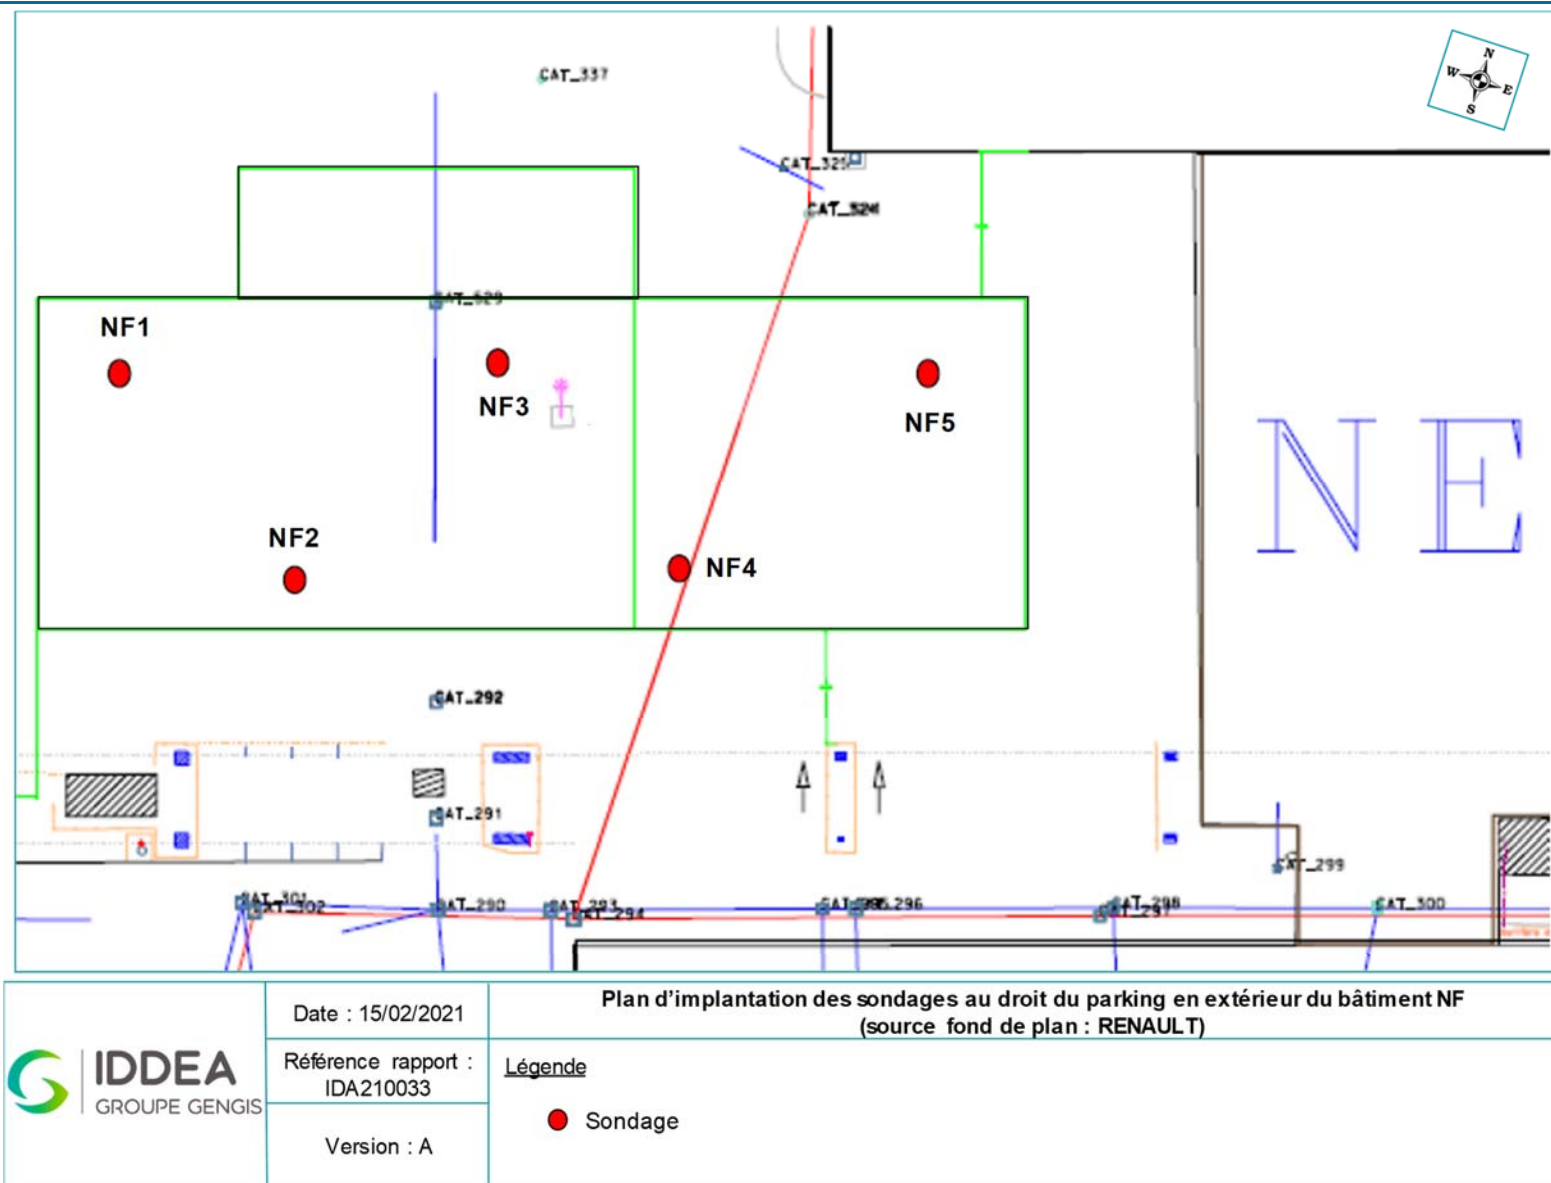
Plan de localisation des investigations sur le parking adjacent au bâtiment NF
